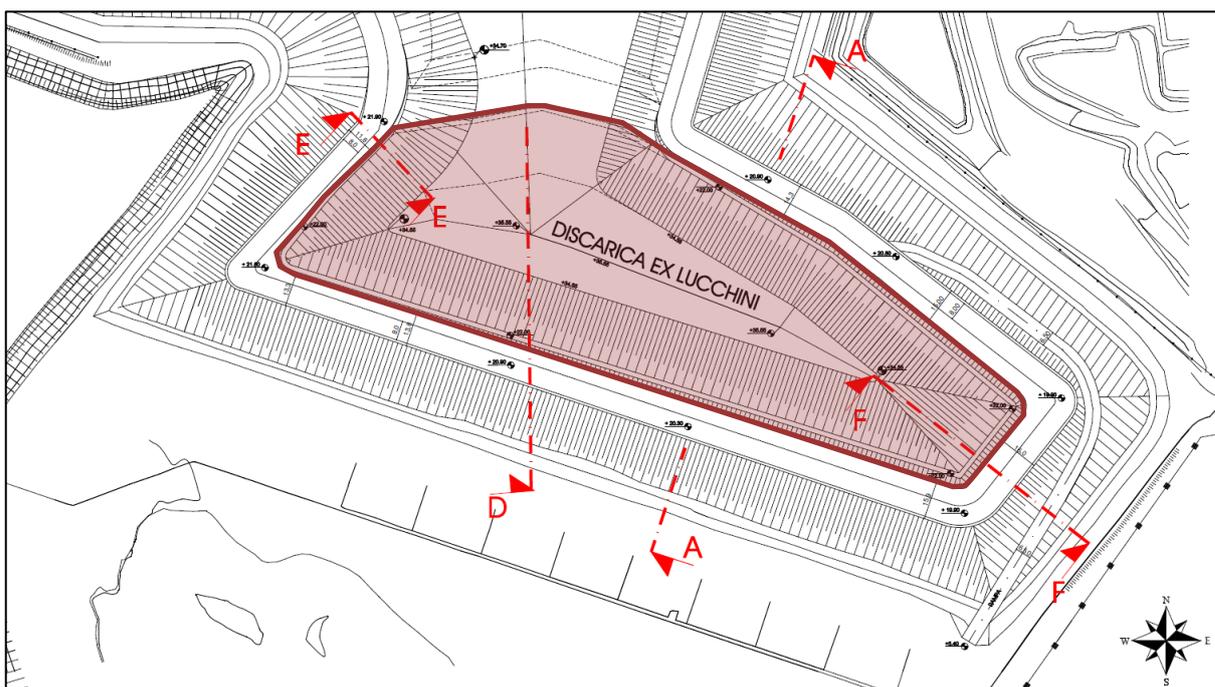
Planimetria con evidenziata area di coltivazione e colmatazione finale di progetto sovralzo ex Lucchini (estratto dalla tavola di progetto TAV.2 VAR_CAP_TAV02_r2)
